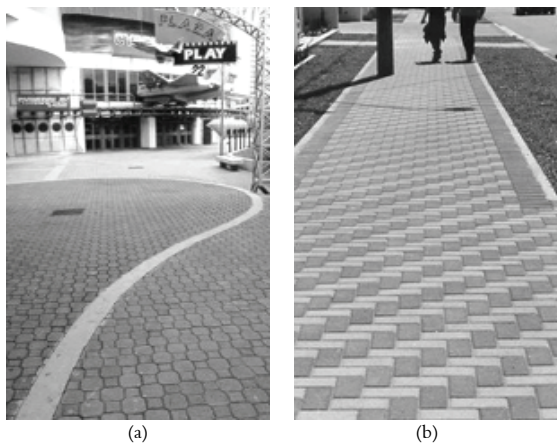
Pavimentos intertravados: a) pátio de shopping center; b) calçada.
